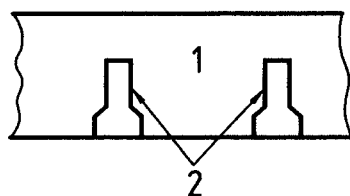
exemple de cas de poutrelles perpendiculaires à la paroi
